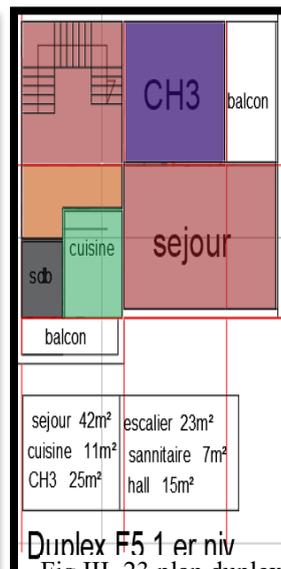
plan duplex F5 1er niv (source : auteur).
